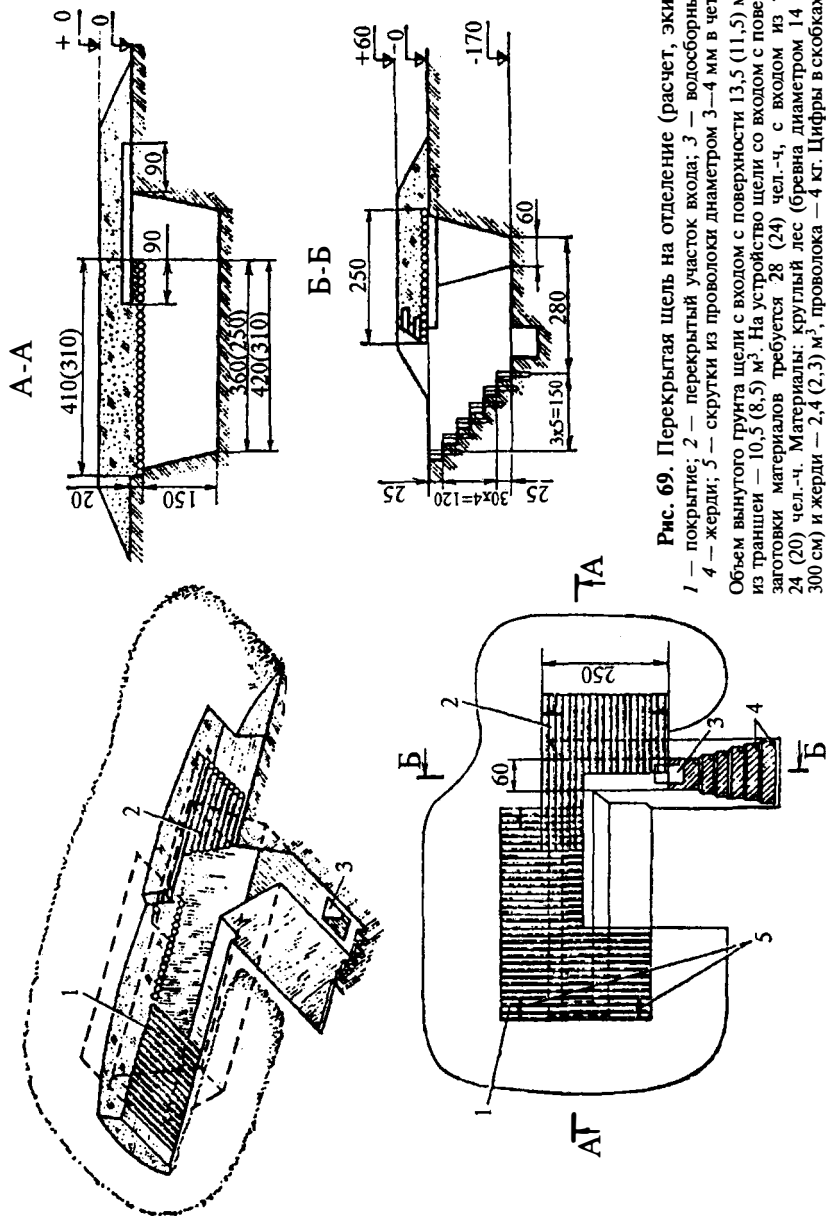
Перекрытая щель на отделение (расчет, экипаж):
